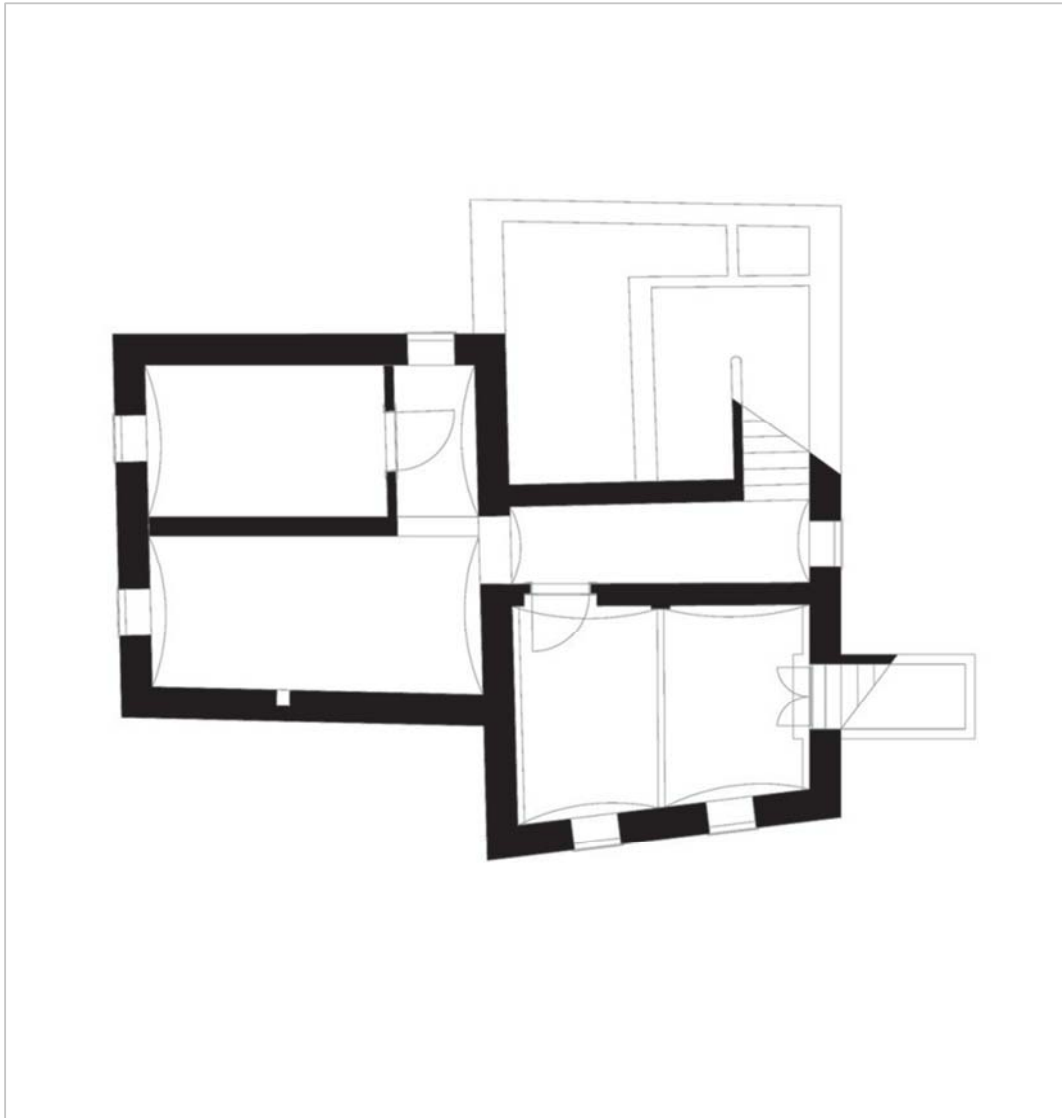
Grundriss des Untergeschoßes 2017
